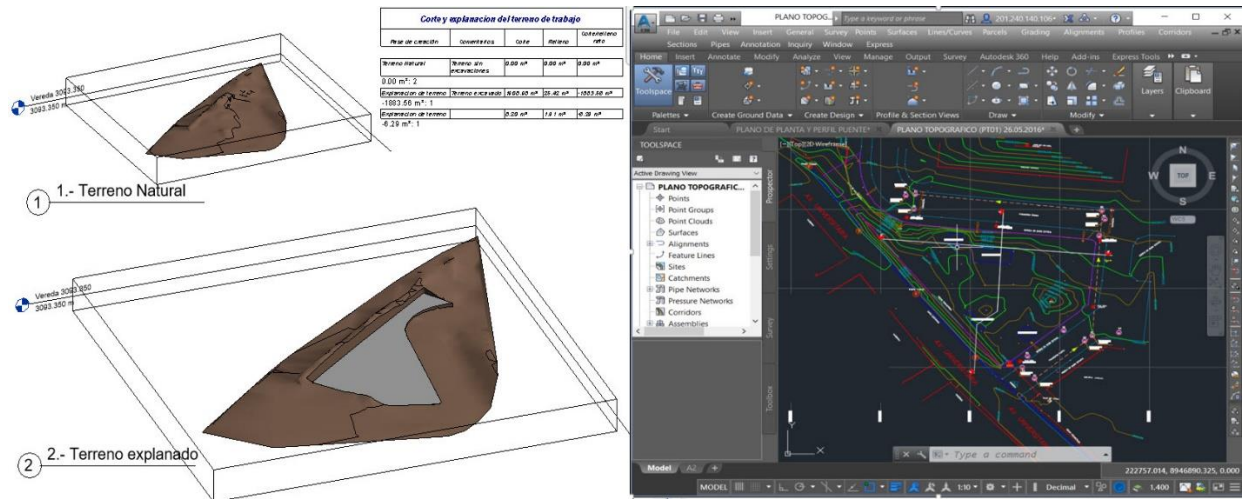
Plano topográfico del proyecto. Revit (Izquierda), AutoCAD Civil 3D 2017 (Derecha).
